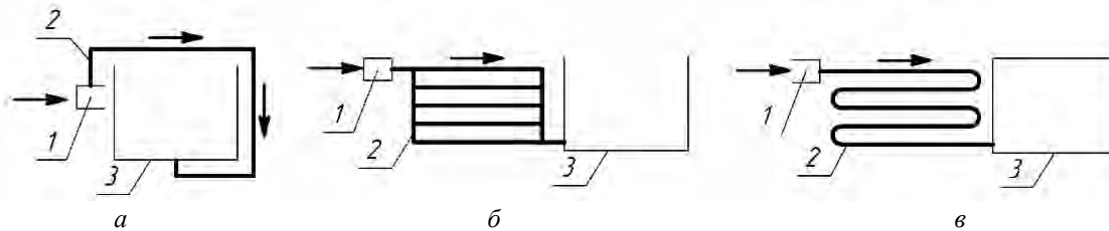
Схеми вкладання ґрунтових теплообмінників за геотермальної вентиляції
